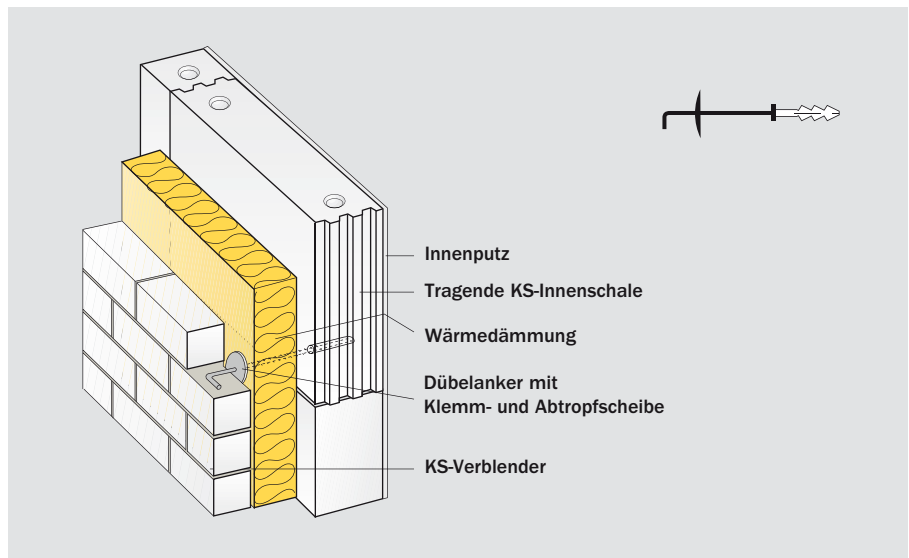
Systemaufbau für zweischaliges Mauerwerk mit Wärmedämmung
